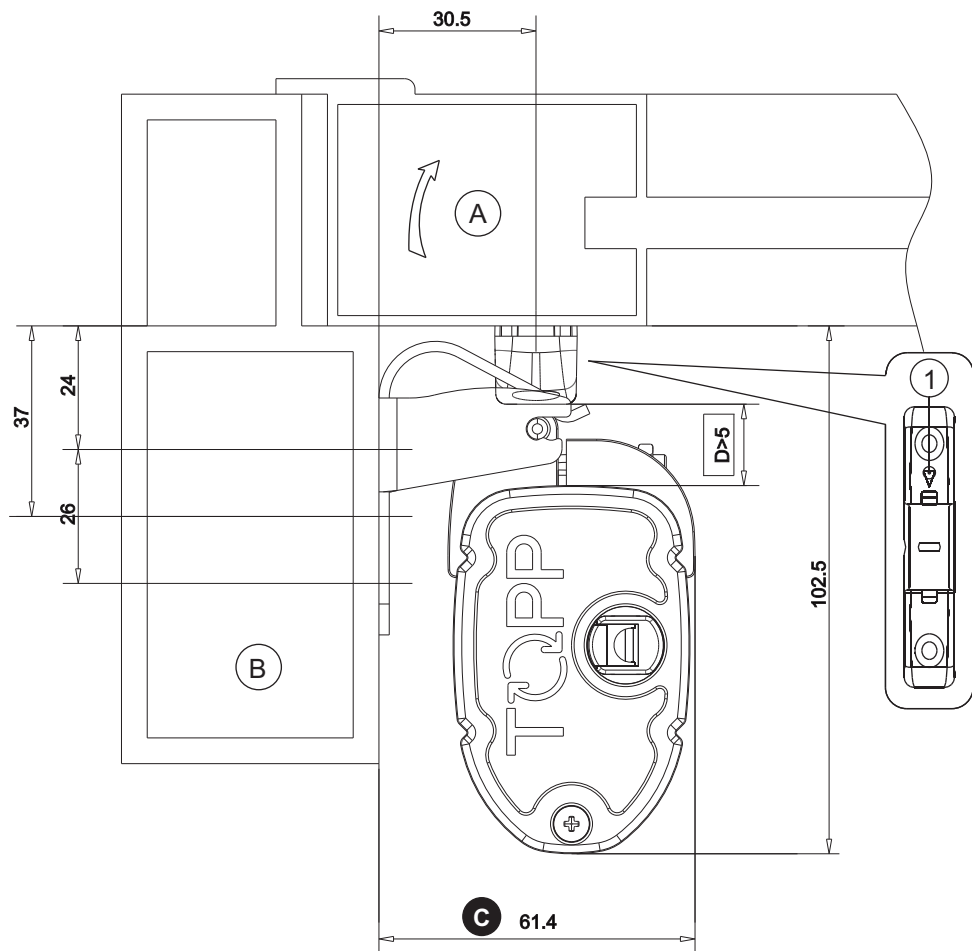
Dimensioni in mm / Dimensions in mm / Dimensions en mm/Abmessungen in mm/Dimensions in mm
